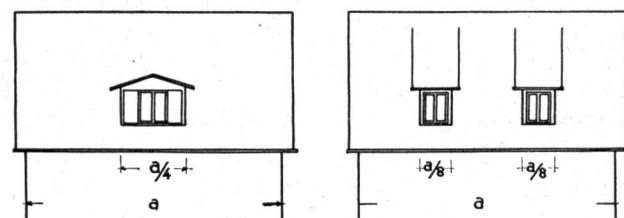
Erlaubte Dachaufbauten in Zone III, IV und V, § 21.
